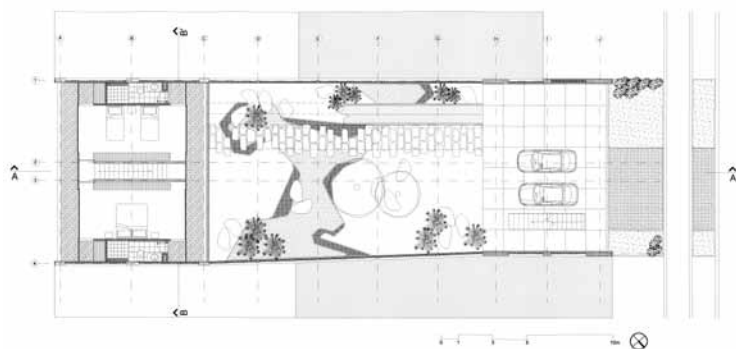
Isaza, Juan Carlos y Ávila, Carlos. Planta primer piso casa-estudio Isaza-Ávila.
